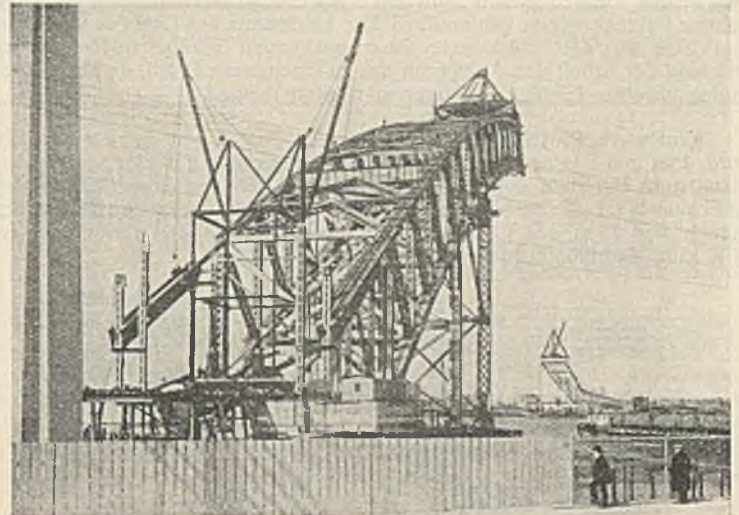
Montage der Hauptöffnung (Richmond, April 1930).
